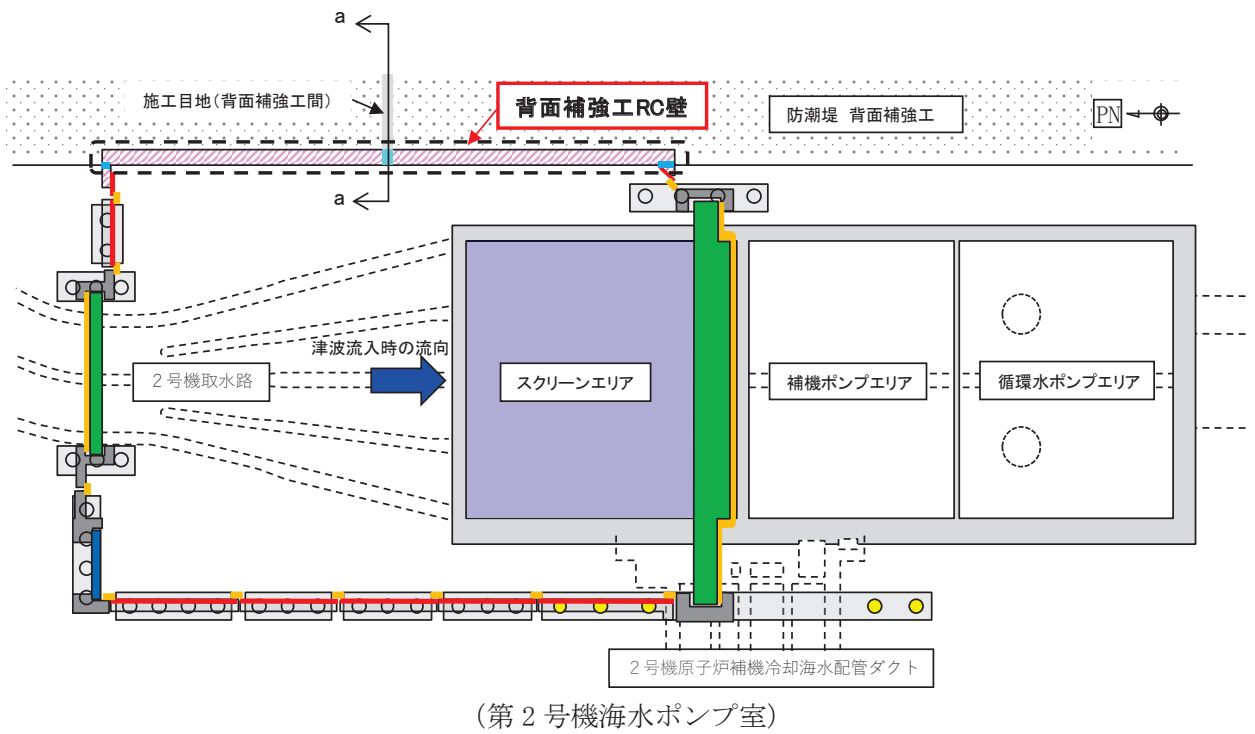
(1) 防潮堤背面補強工部の構造概要図 (平面図)
